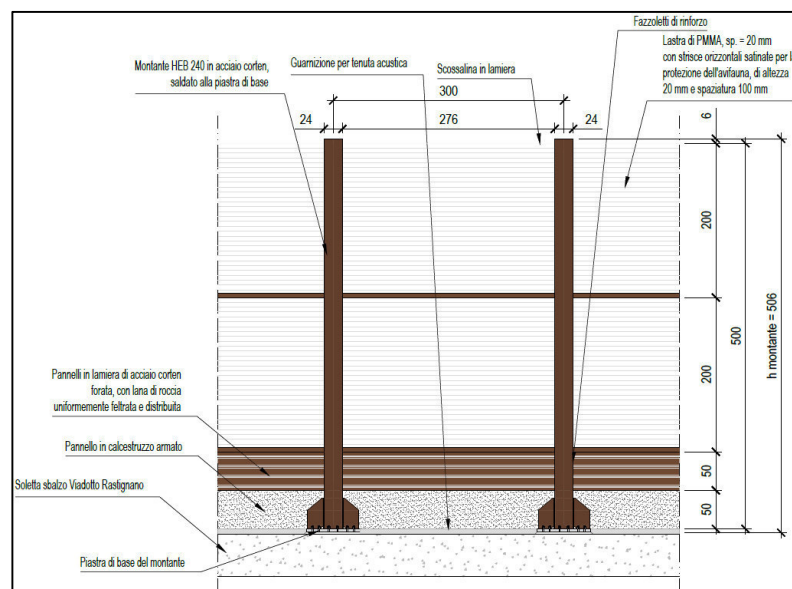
Prospetto delle barriere trasparenti da 5 metri
